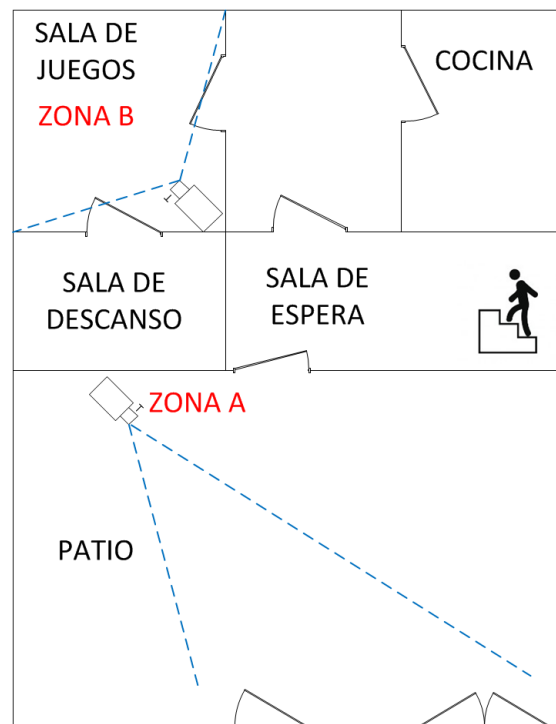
Plano con ubicación de las cámaras y alcance de visión
